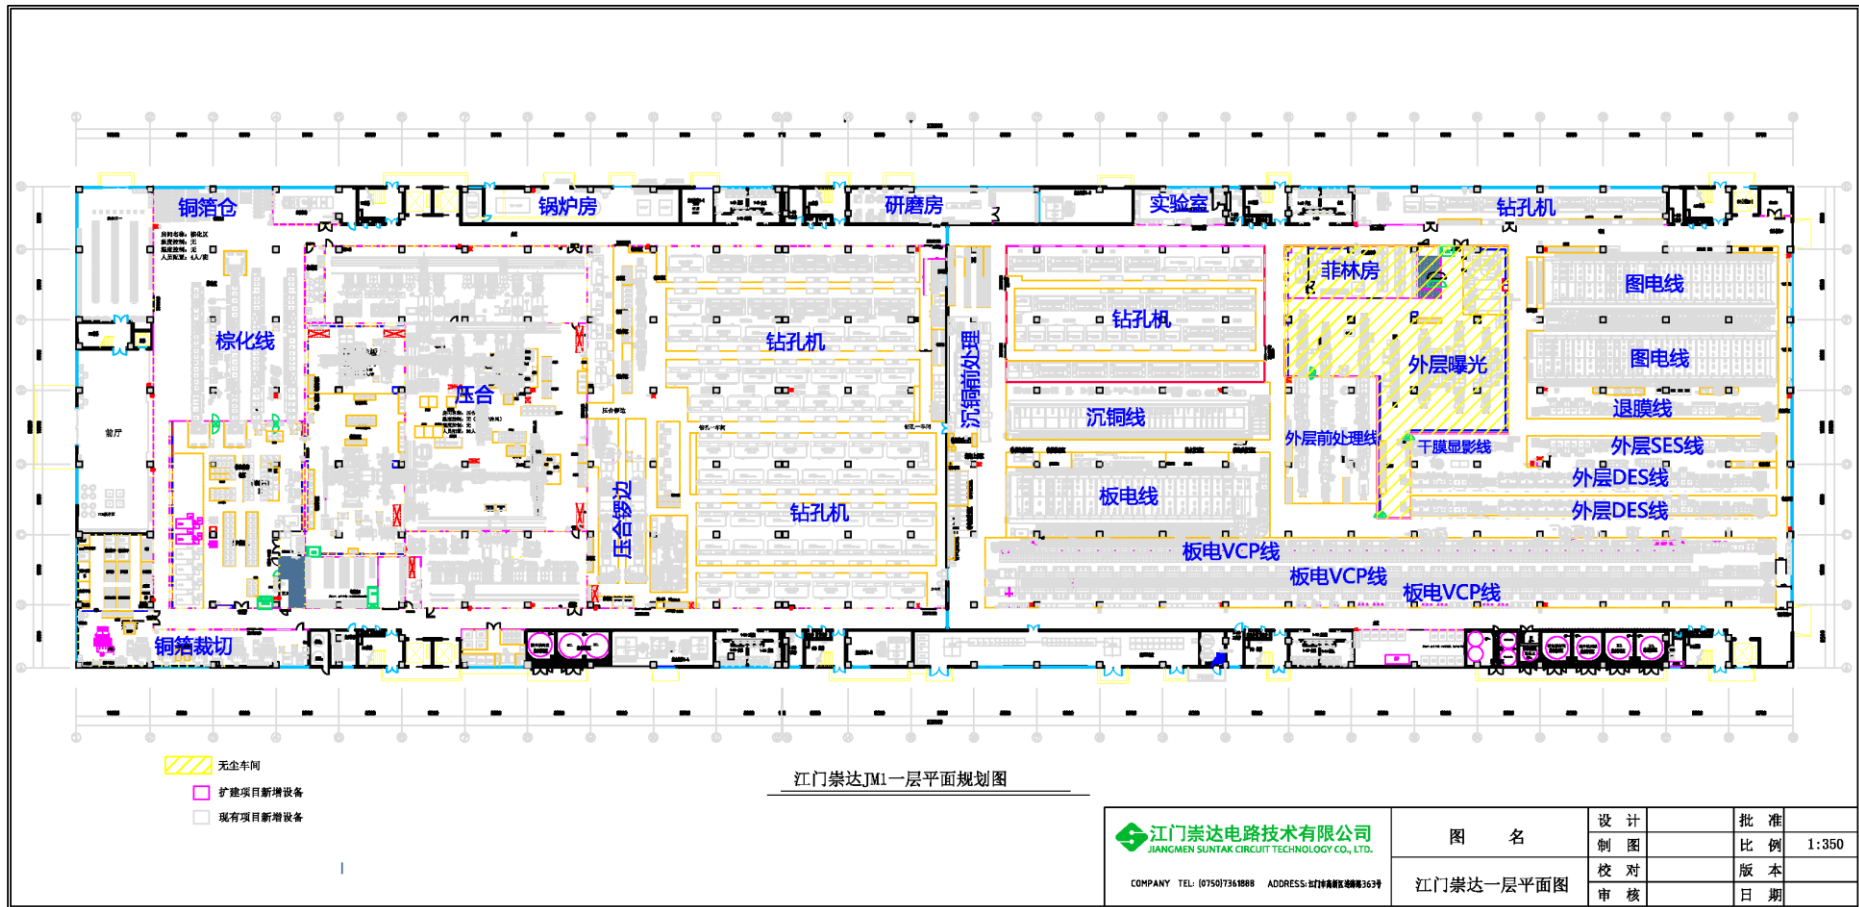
(a) 现有项目厂房一 1F 车间平面布置图
